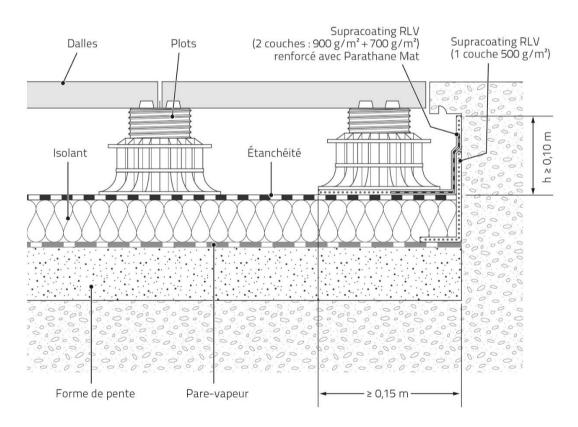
Protection par dalles sur plots: exemple d'un seuil
